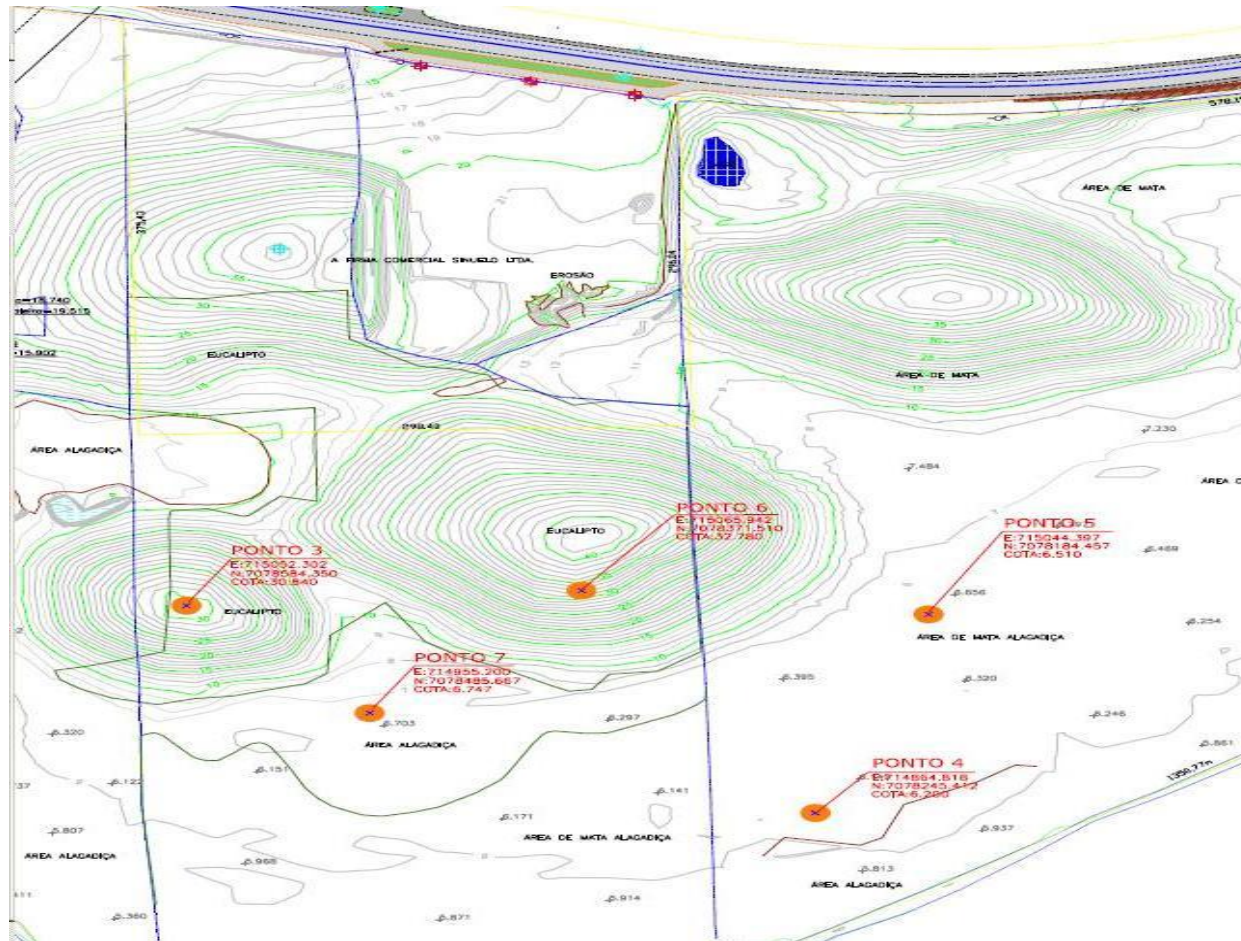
Detalhe da Planta com a localização das sondagens a percussão efetuadas na área do projeto.
